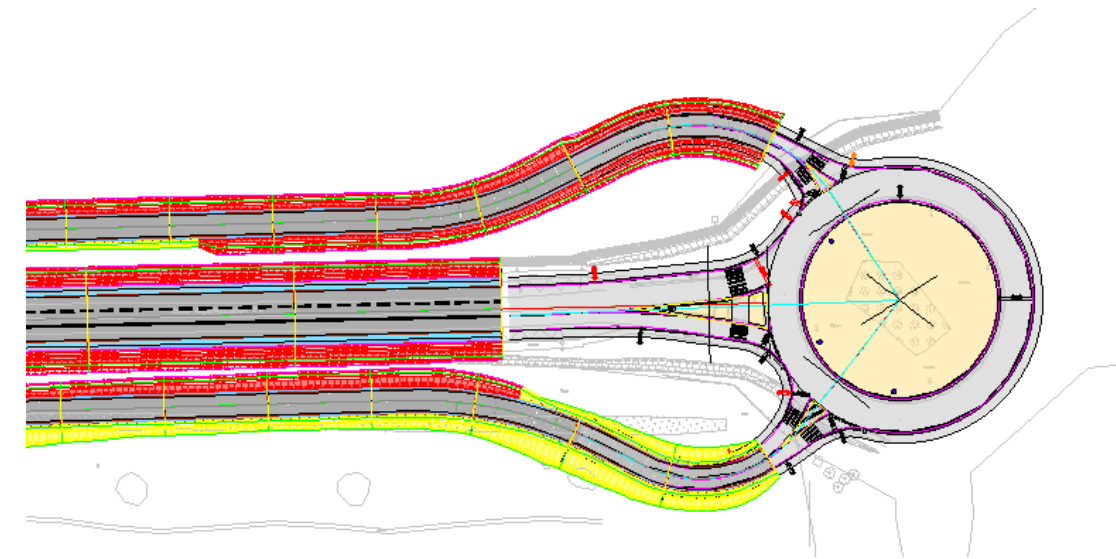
plan de détail de la sortie du giratoire des Fontenelles à 2 voies
